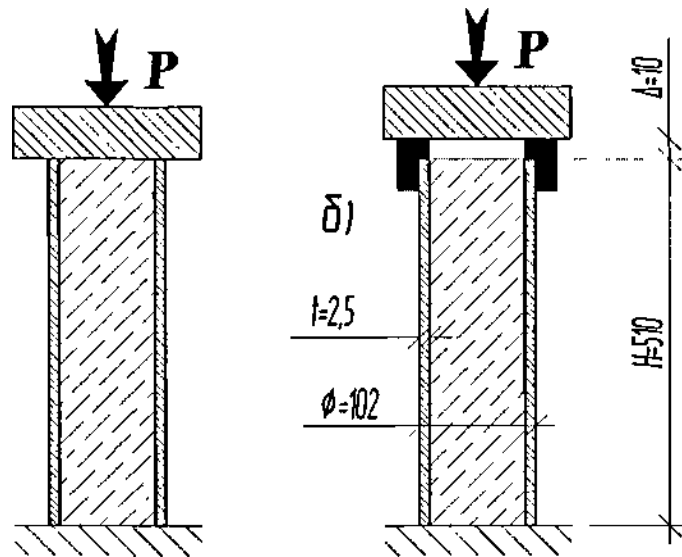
Схеми випробувань трубобетонних зразків: а - передача зусиль на весь переріз (на сталеву оболонку і бетонне ядро); б - те ж на оболонку за допомогою опорного коміра або кільця
